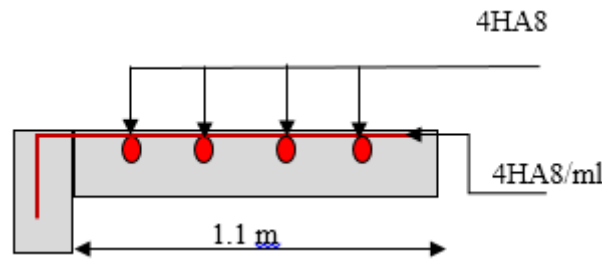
Schéma de ferrailage de la dalle sur un deux appuis.
